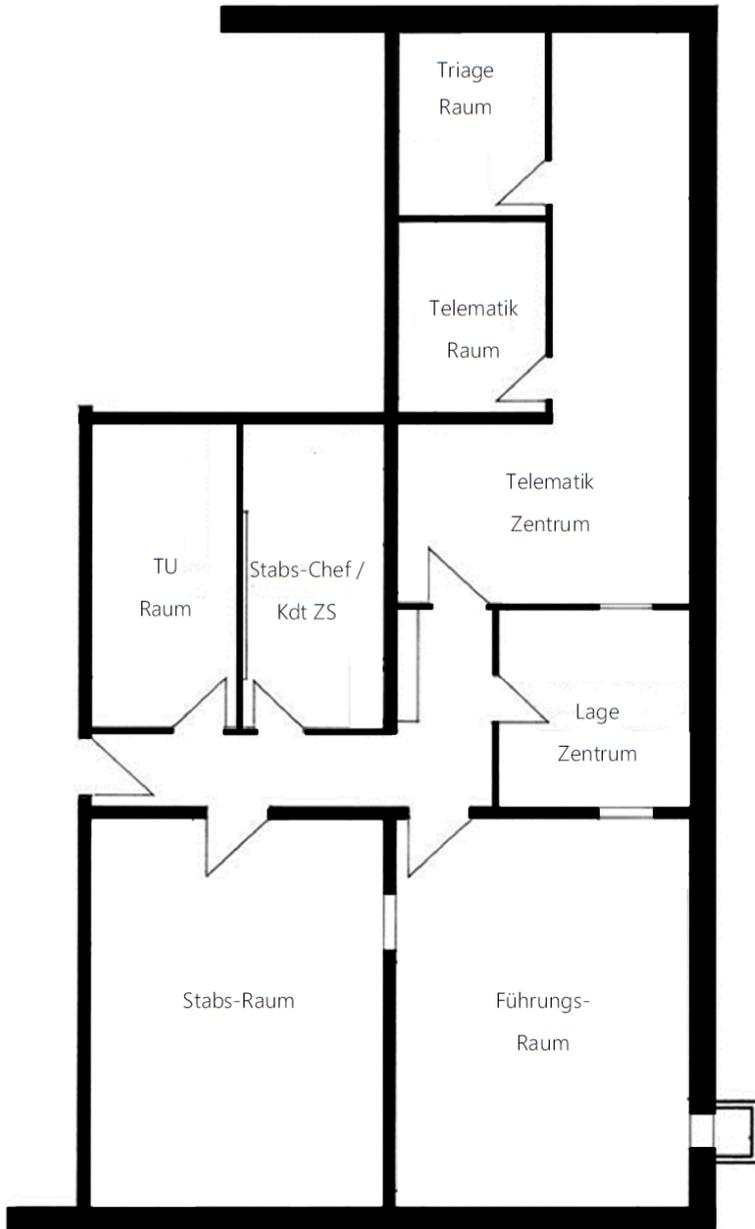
Grundriss Kommandoposten Typ I.
